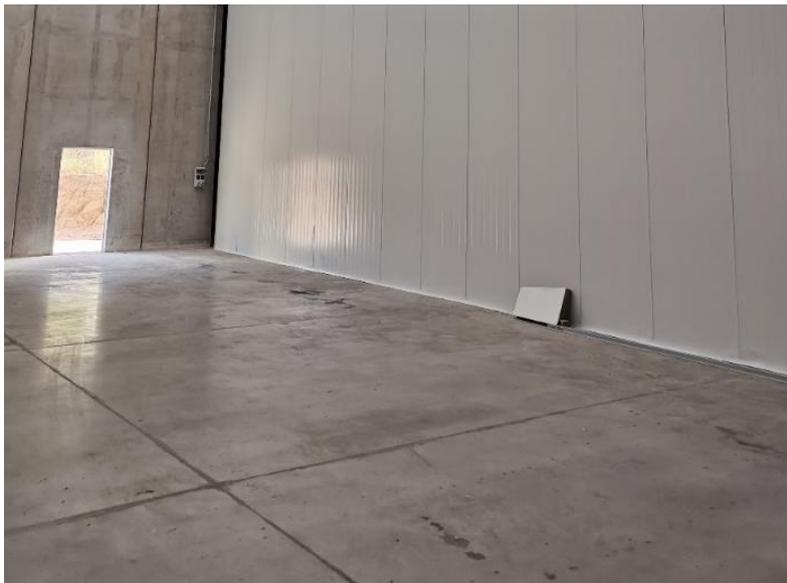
Pavimento de hormigón fratasado (Elaboración propia, 2024)
